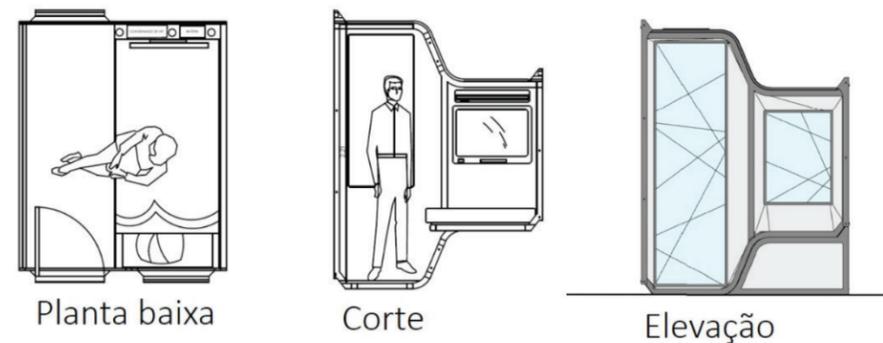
Planta Baixa, Corte e Elevação do Módulo individual
